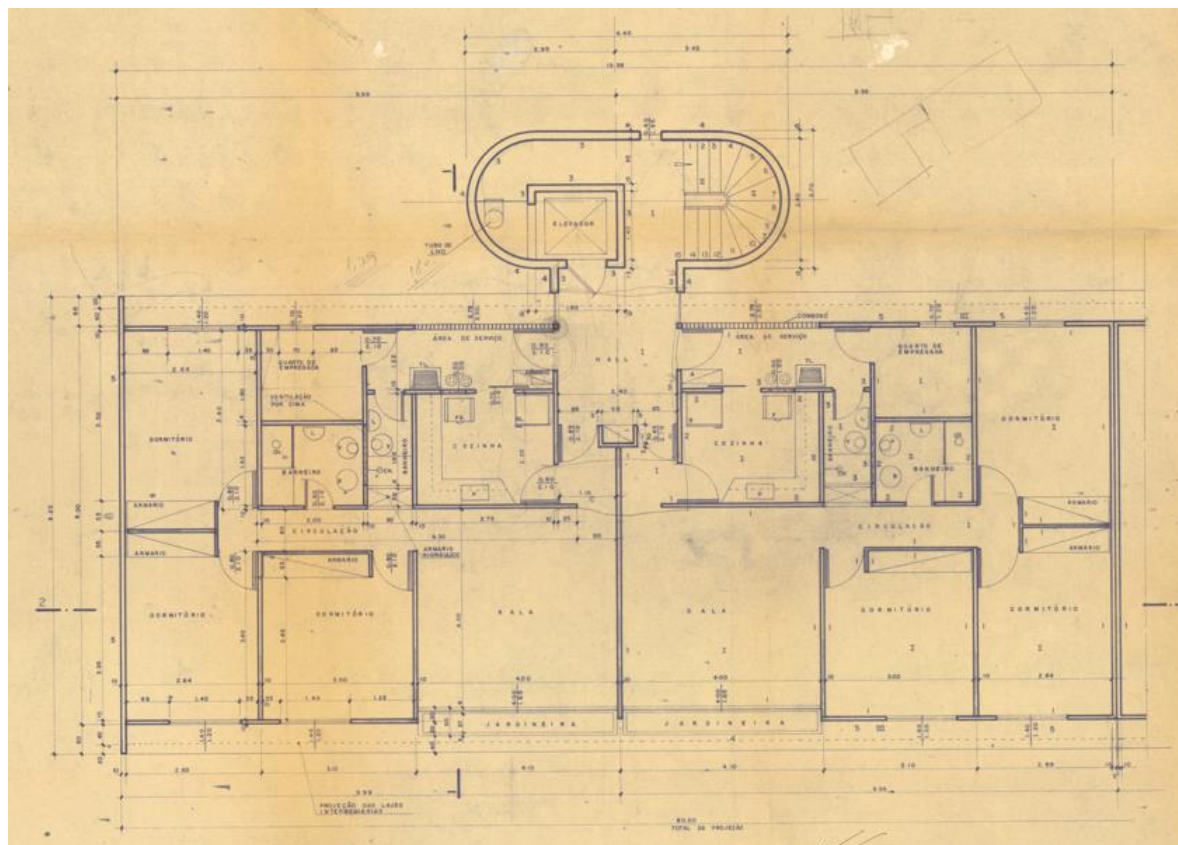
Planta baixa do pavimento tipo do R2-72. Fonte: Acervo do Arquiteto Milton Ramos.
